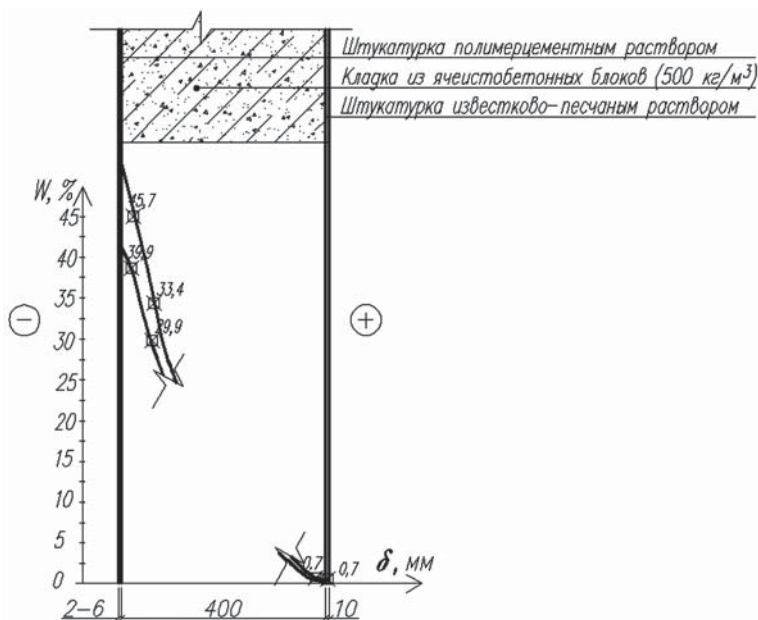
Распределение массовой влажности по толще наружной стены жилого дома в конце отопительного периода (по данным натурального обследования) (верхняя кривая — для наружной стены ориентированной на север; нижняя кривая — для наружной стены ориентированной на юг)
